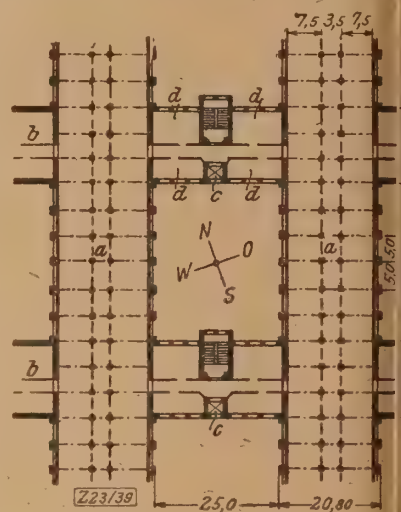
Anordnung der Geschosbauteile Teilgrundriss.
